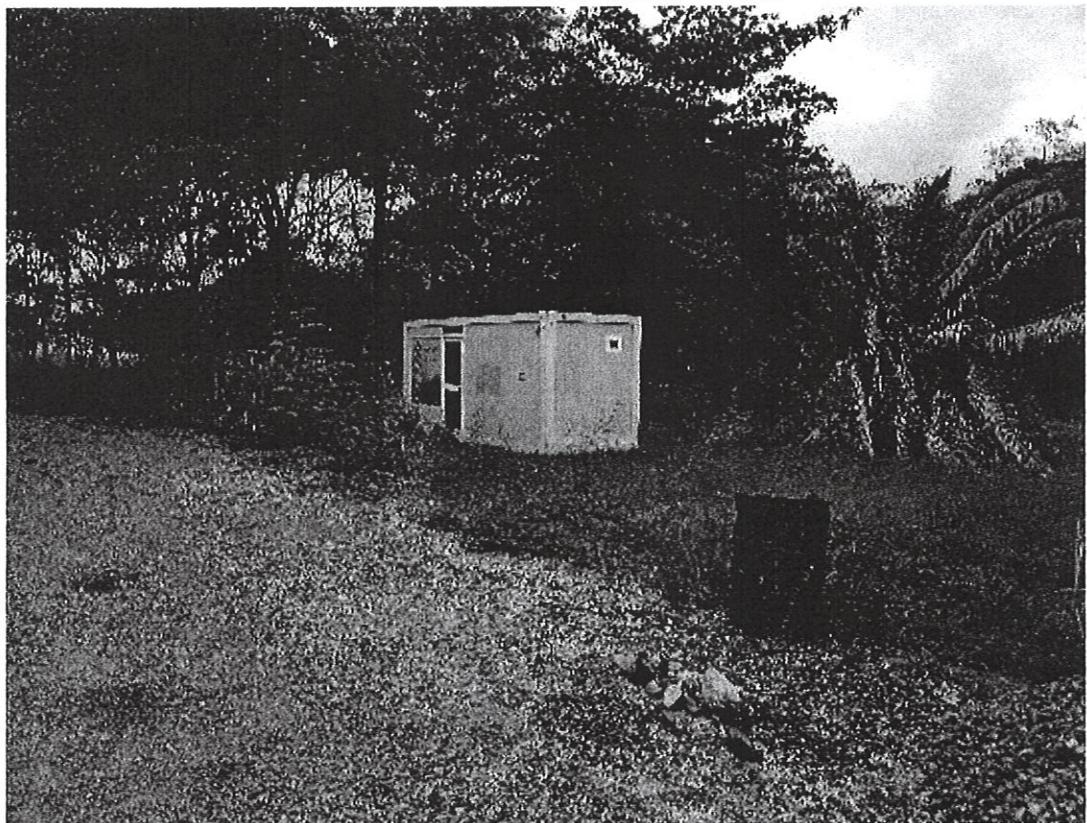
Oficina del proyecto, tanque de basura.
